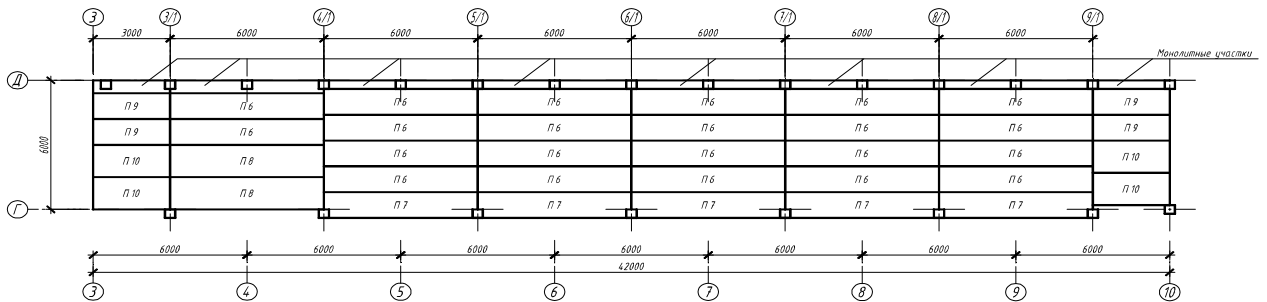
Схеми розташування плит перекриття в осях 3-10 та Г-Д на відм.
